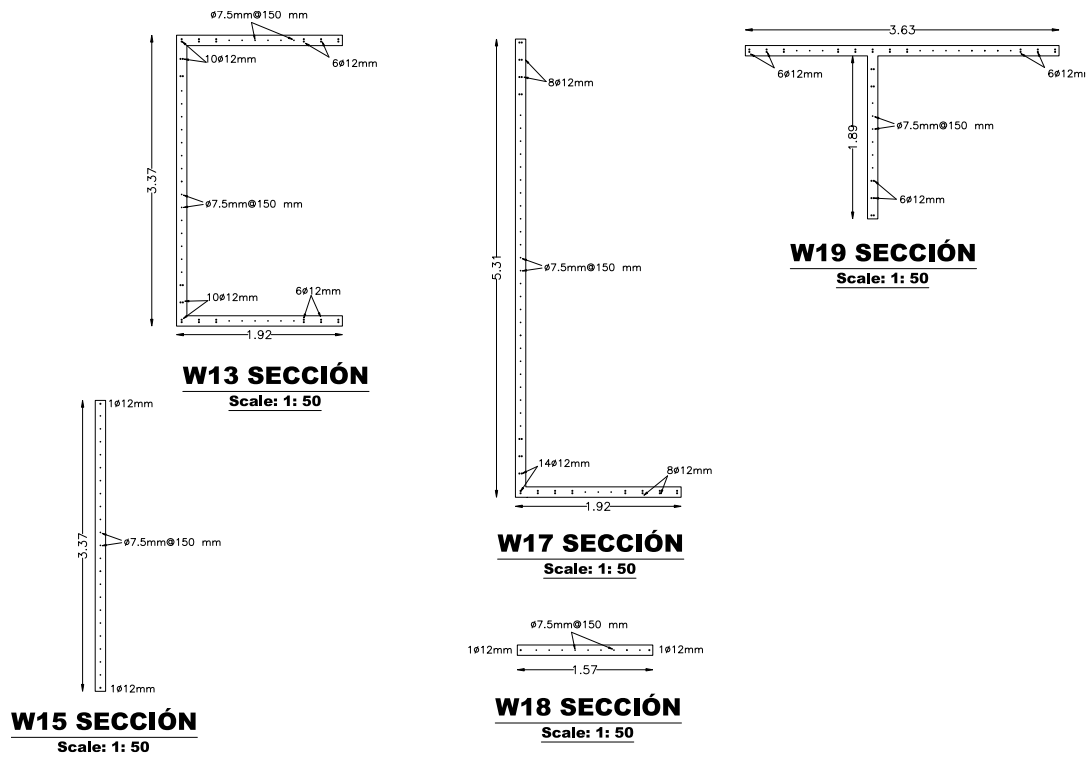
Geometría y refuerzo típico de los muros delgados (a) Muro W13, (b) Muro W15, (c) Muro W17, (d) Muro W18, y (e) Muro W19.
